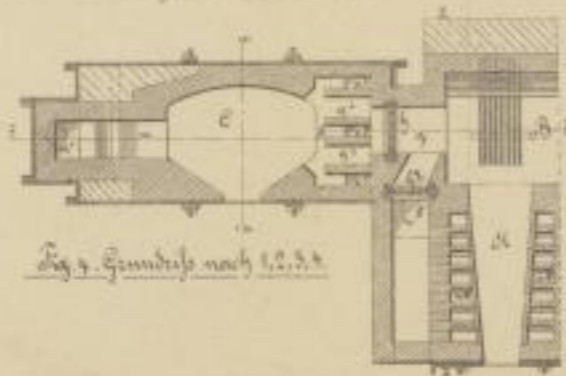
Grundriss nach 1, 2, 3, 4
